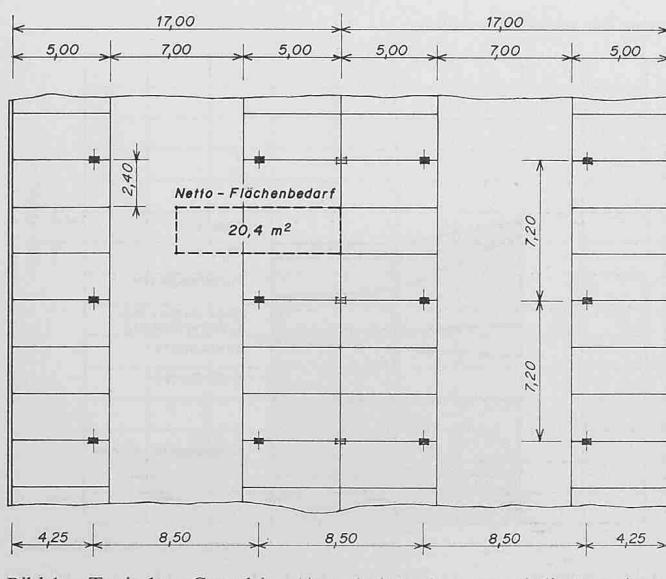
Typischer Grundriss (Ausschnitt) einer unterirdischen Autoabstellanlage
